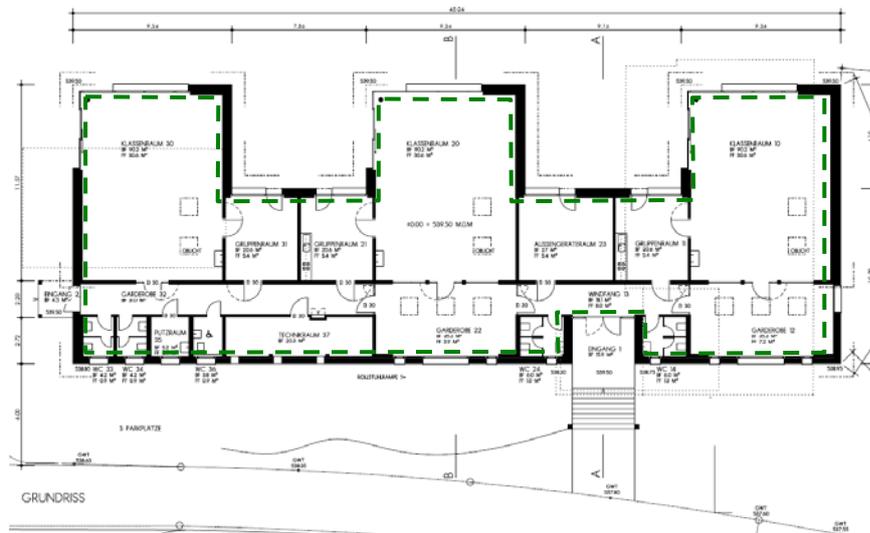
Grundriss mit eingetragener Luftdichtigkeitsebene
